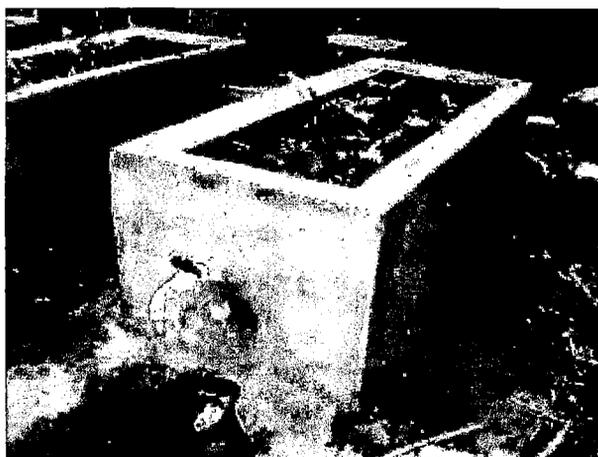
Humedal artificial construido de material noble. Fuente propia
